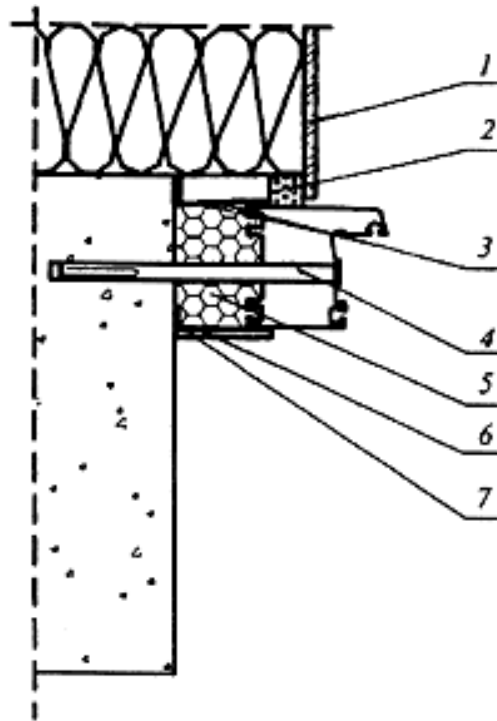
Узел бокового примыкания оконного блока к проему стены из бетона с наружным утеплением фасада и установкой внутреннего декоративного нащельника:
